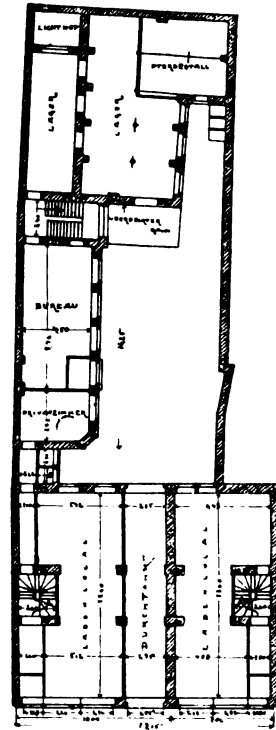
Flingerstrasse 22/26. Erdgeschoss. 1:500.
